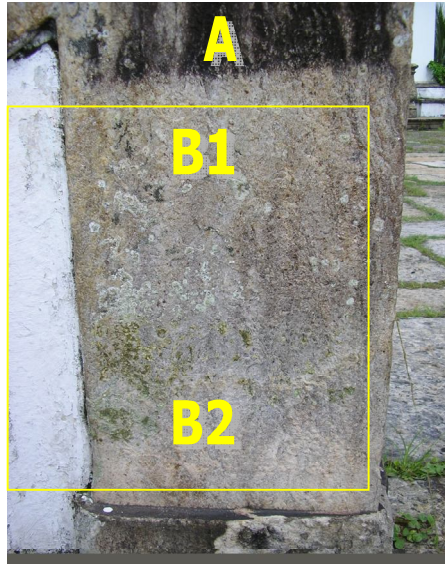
Vista da pilastra após a limpeza com emplasto de bentonita (B1) e com pasta AB-57 (B2)
